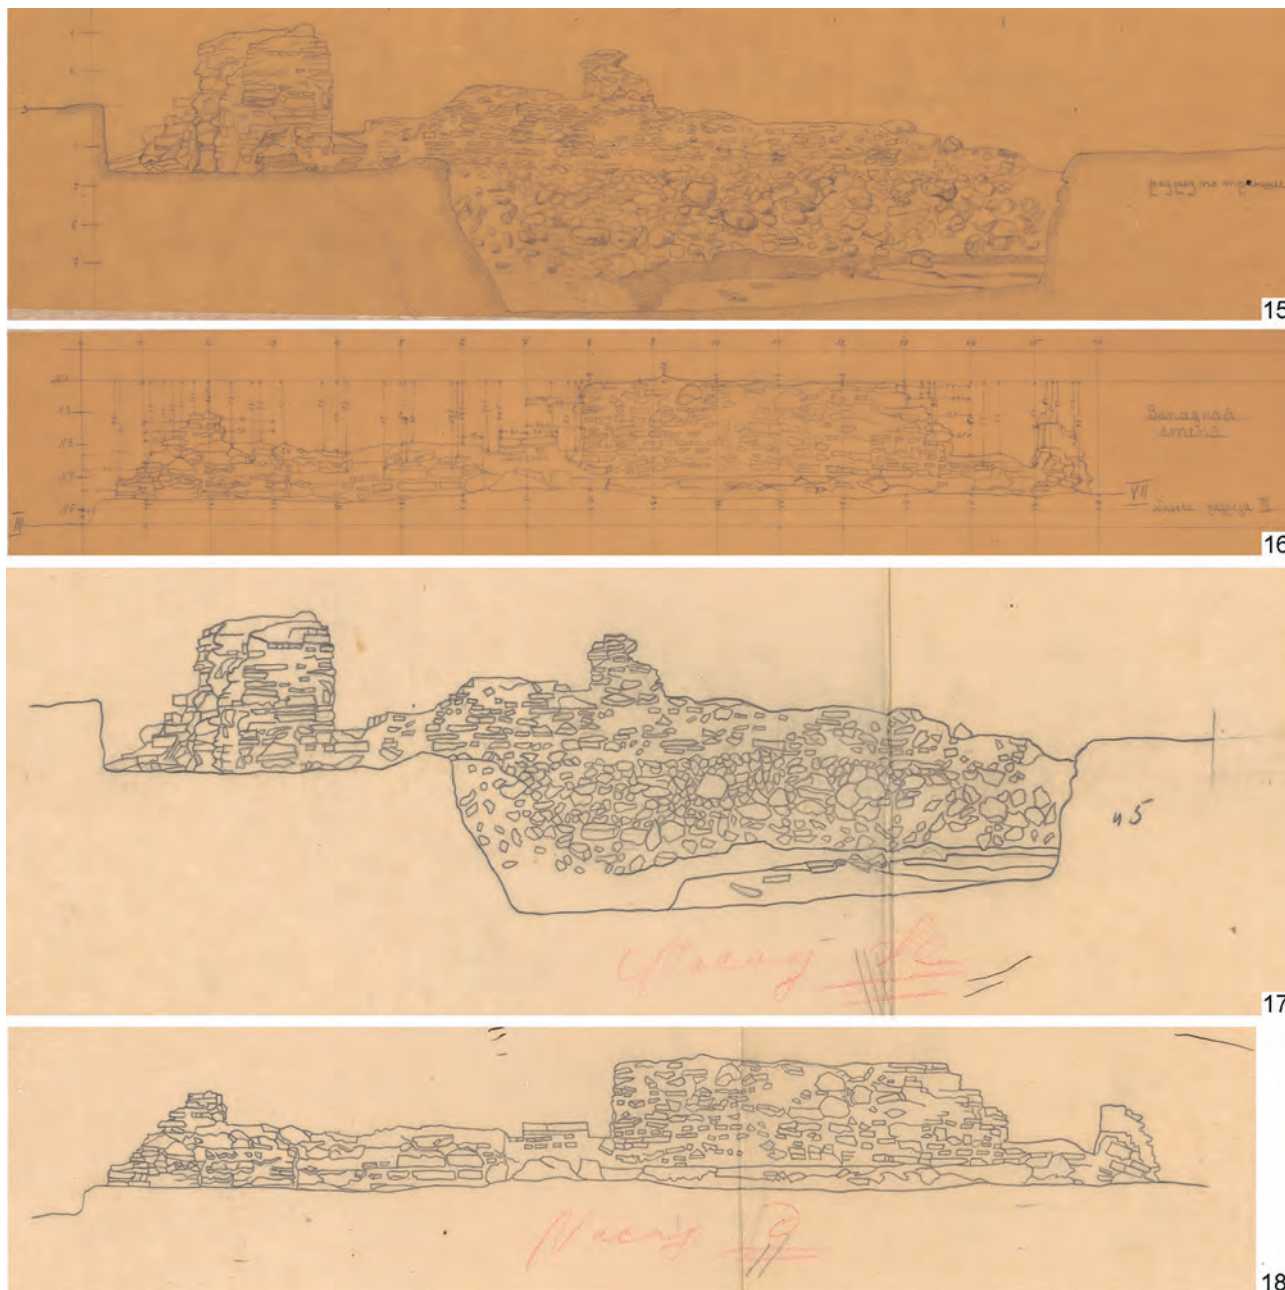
Разрезы южного фасада южной стены (15, 17) и западного фасада западной стены (16, 18) церкви Св. Климента
